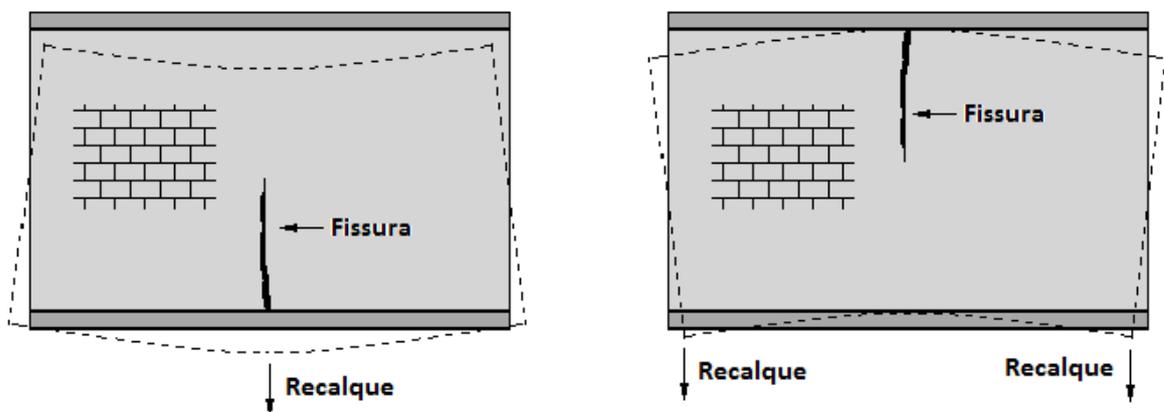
Fissuração por recalque provocado por fundação vizinha.
